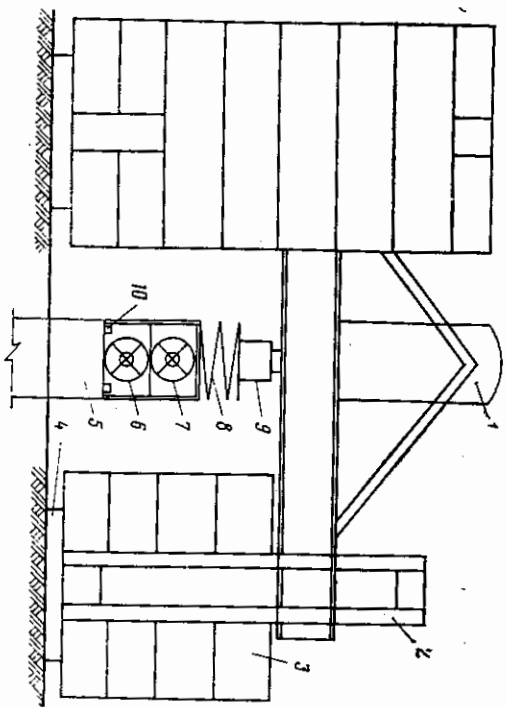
Схема экспериментальной установки для испытаний свай динамическими нагрузками
